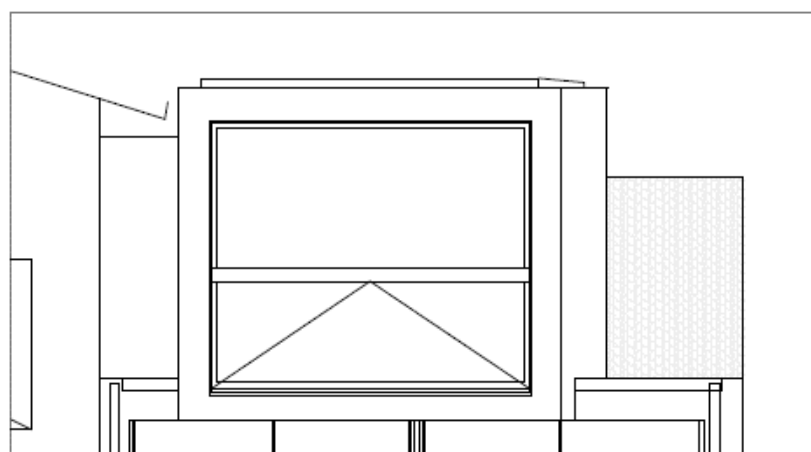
Planta do edifício Gaia: alçado piso 1
